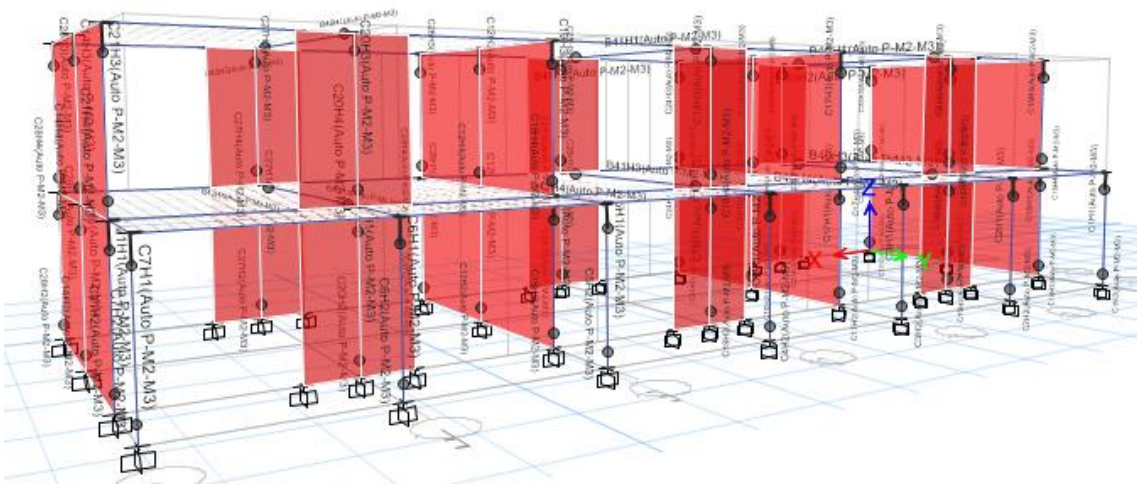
Asignación de rotulas plásticas en el pabellón 3 con placas de concreto armado.
